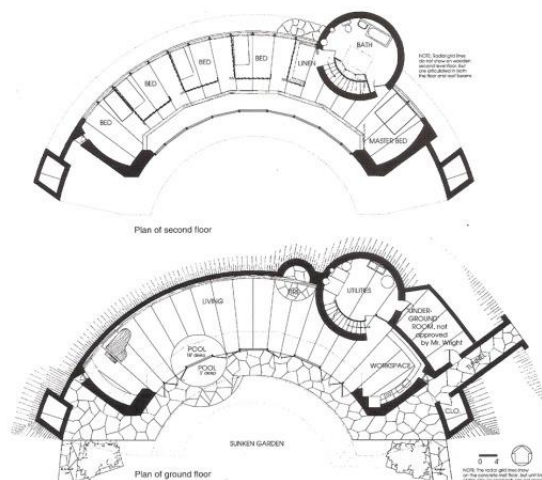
Plantas da Jacobs House II (piso inferior e superior)
